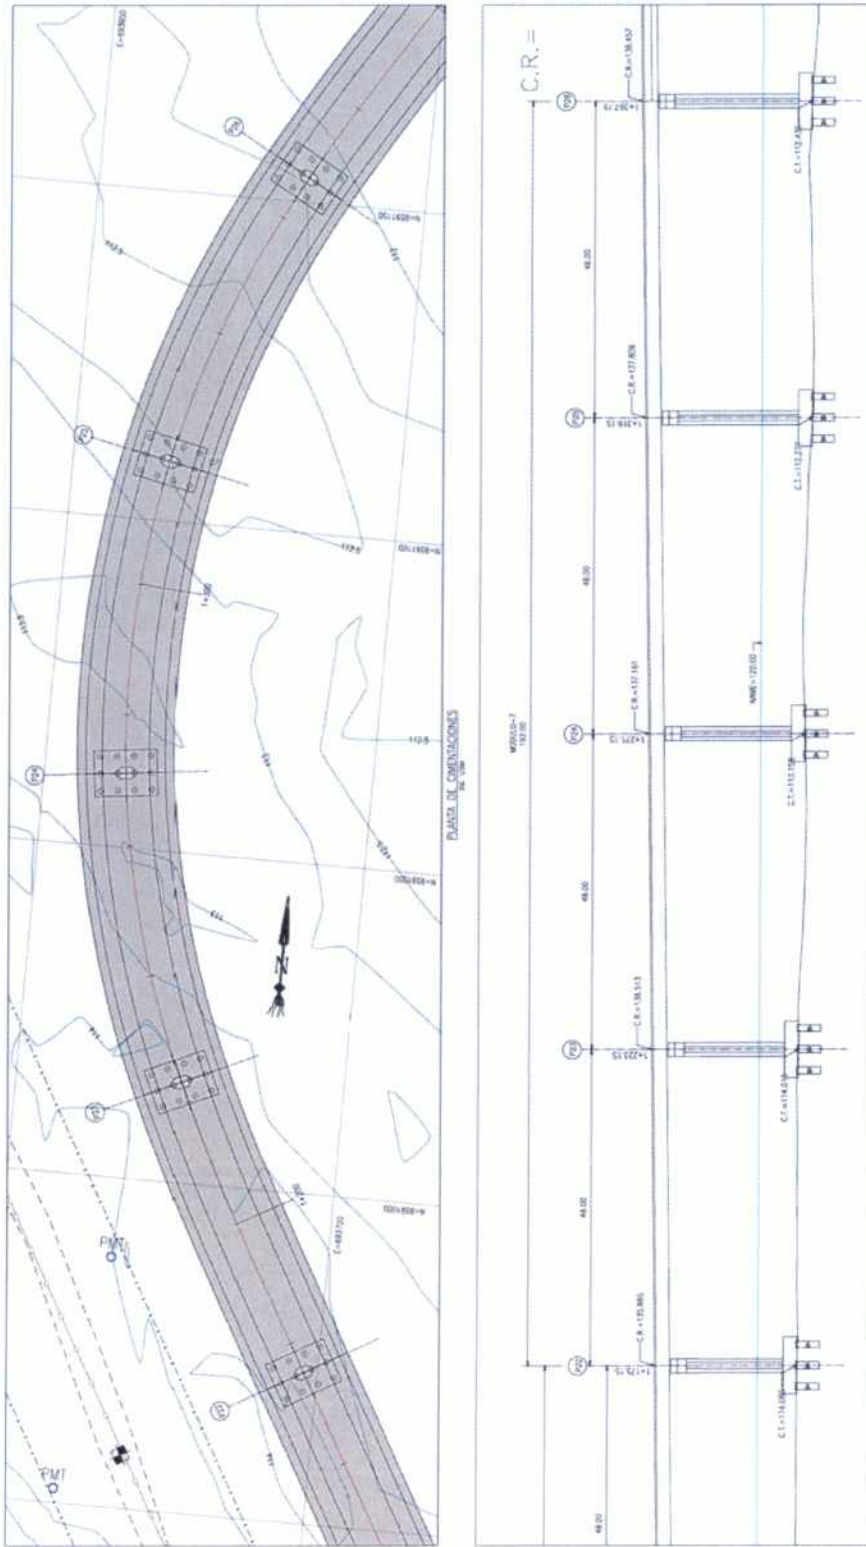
Viaducto: Módulo Típico Curvo, Planta y Elevación
